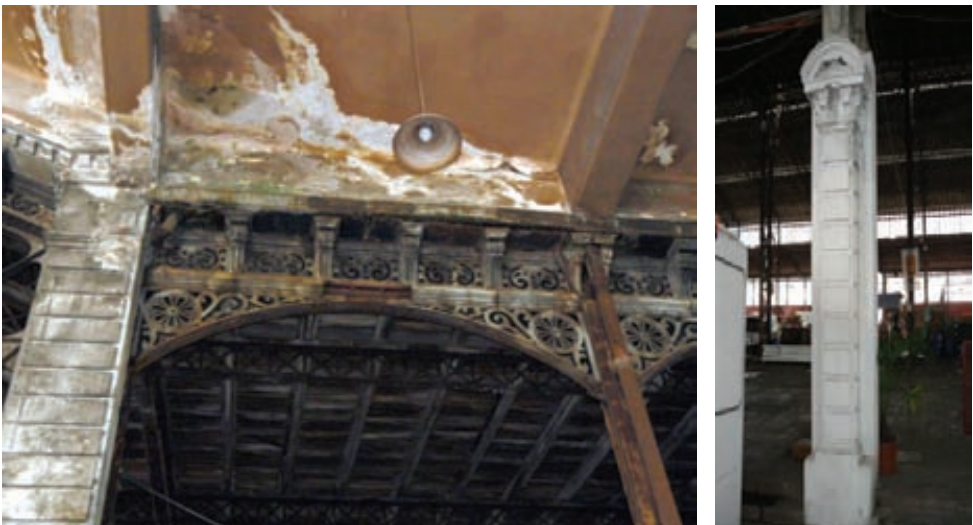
Detalles de fachada hacia edificio hormigón C/JJ. Amézaga
